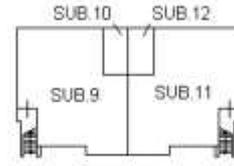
elaborato planimetrico catastale (fuori scala) :
